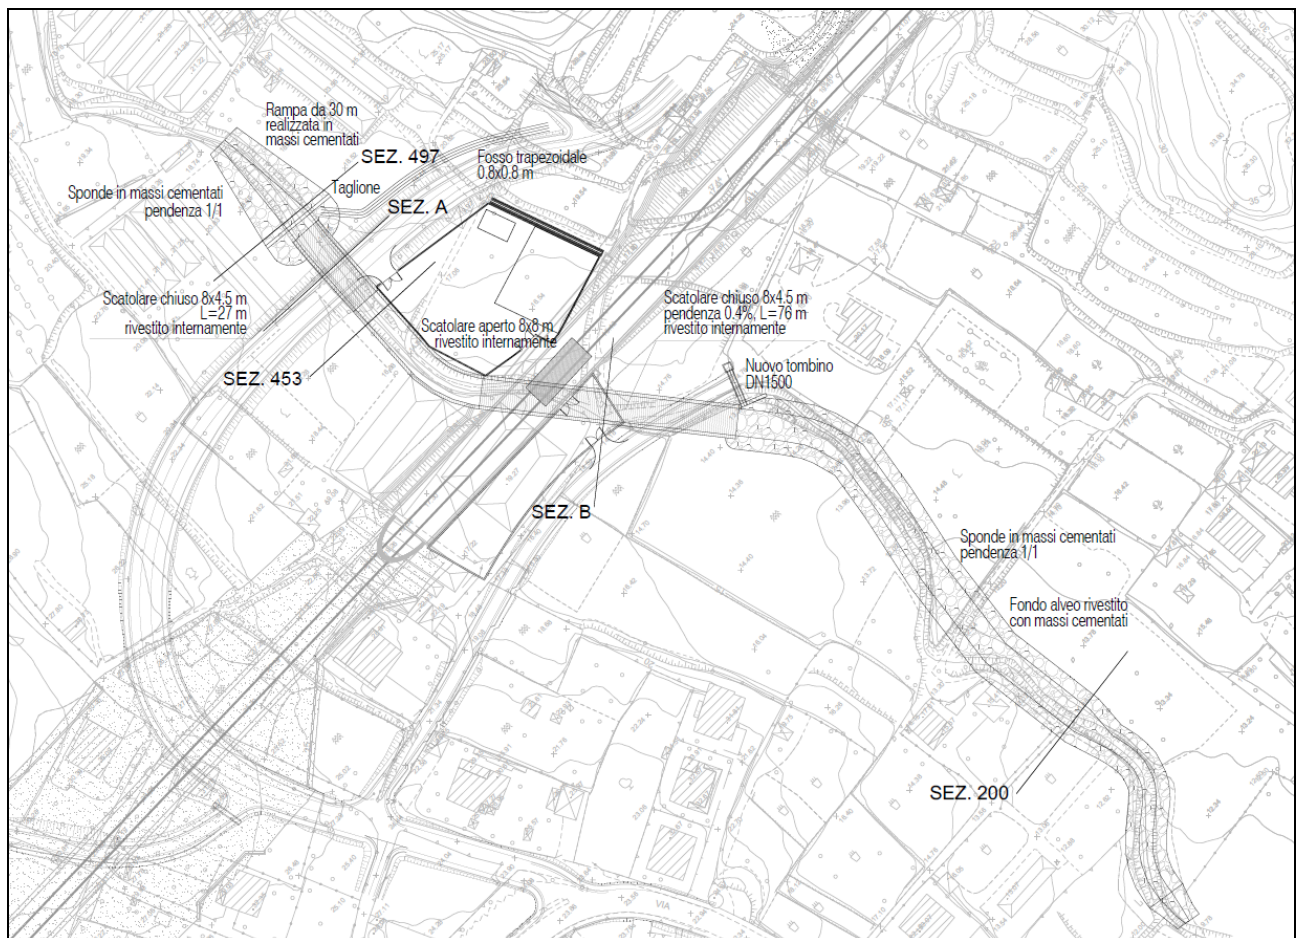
Planimetria della sistemazione idraulica di progetto.
